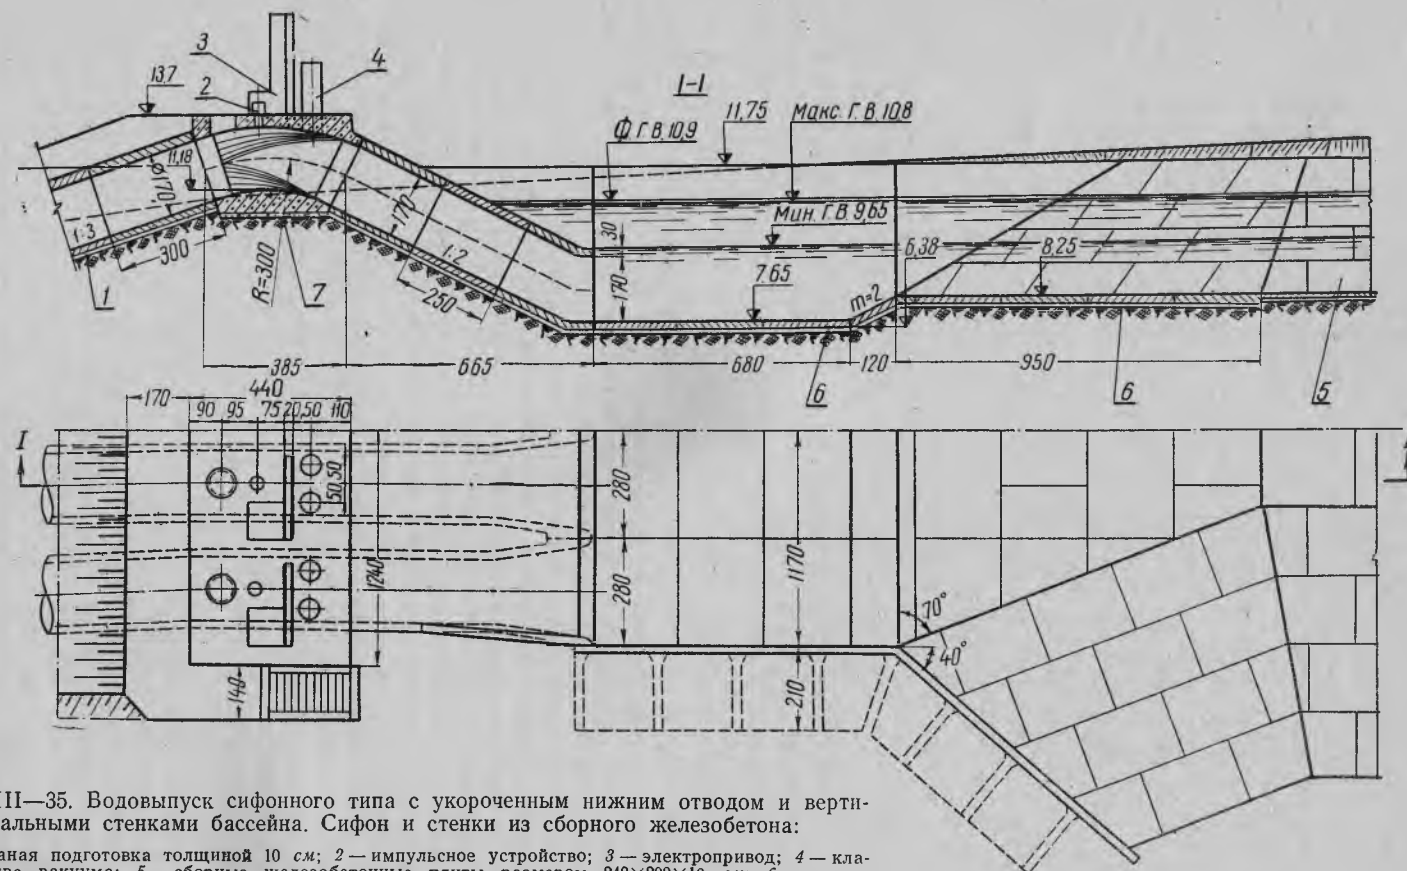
Водовыпуск сифонного типа с укороченным нижним отводом и вертикальными стенками бассейна. Сифон и стенки из сборного железобетона:
